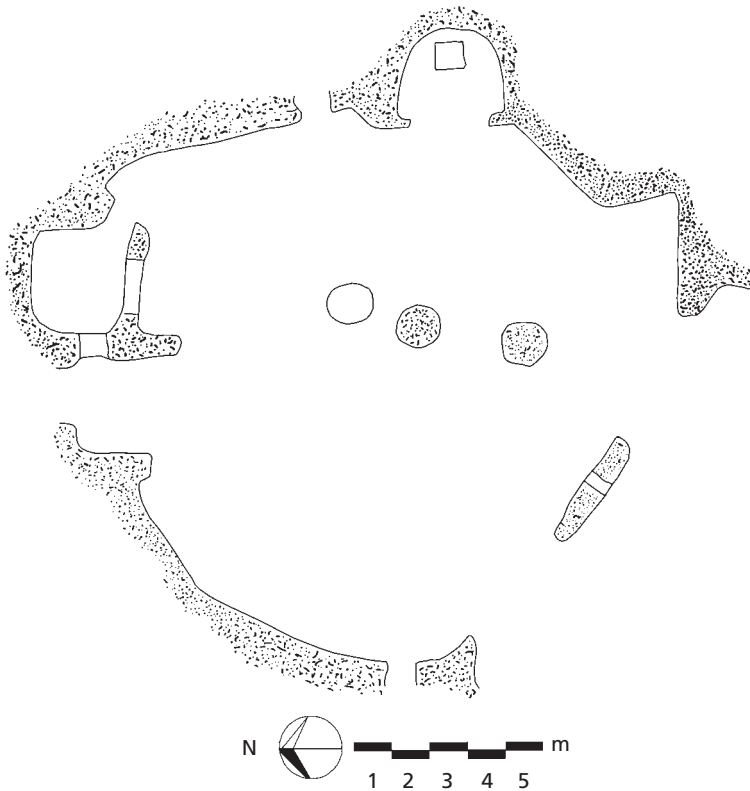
Tūr 'Abdin, Kloster Mar Stephanos, Klosterkirche, Grundriss. – (Nach Wießner, Christliche Kultbauten 1, Fig. 32).
